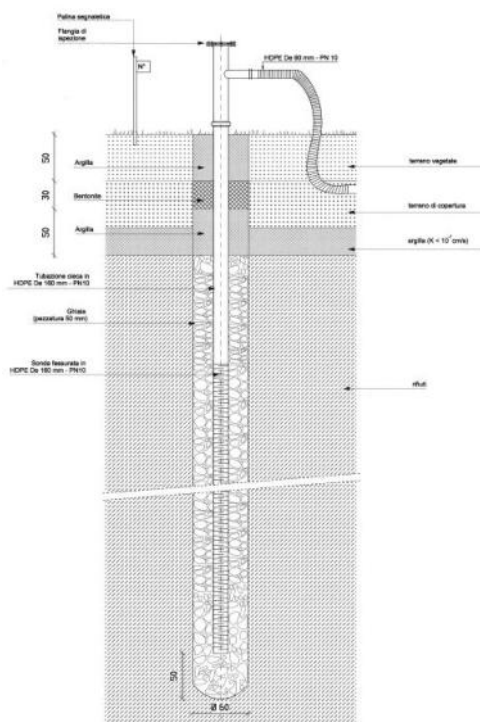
Sezione schematica delle sonde di aspirazione verticali da progetto approvato
